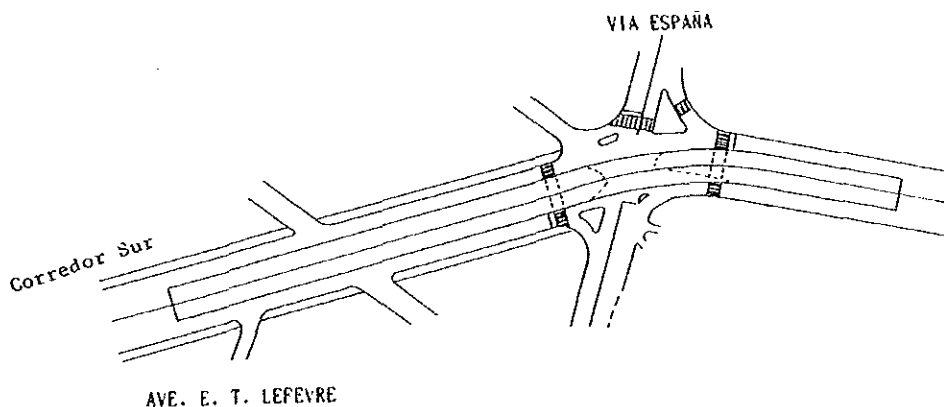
PLAN DE INTERSECCION DE VIA E.T. LEFEVRE CON VIA ESPAÑA
